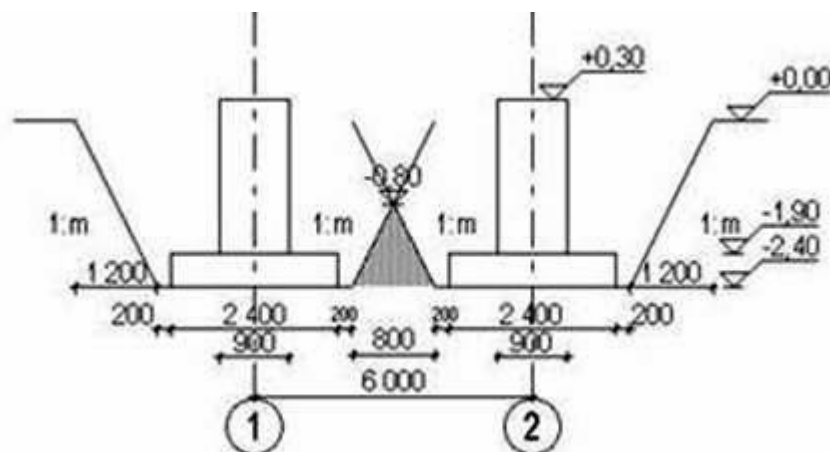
б. Поперечный профиль разреза фундаментов (фрагмент)
